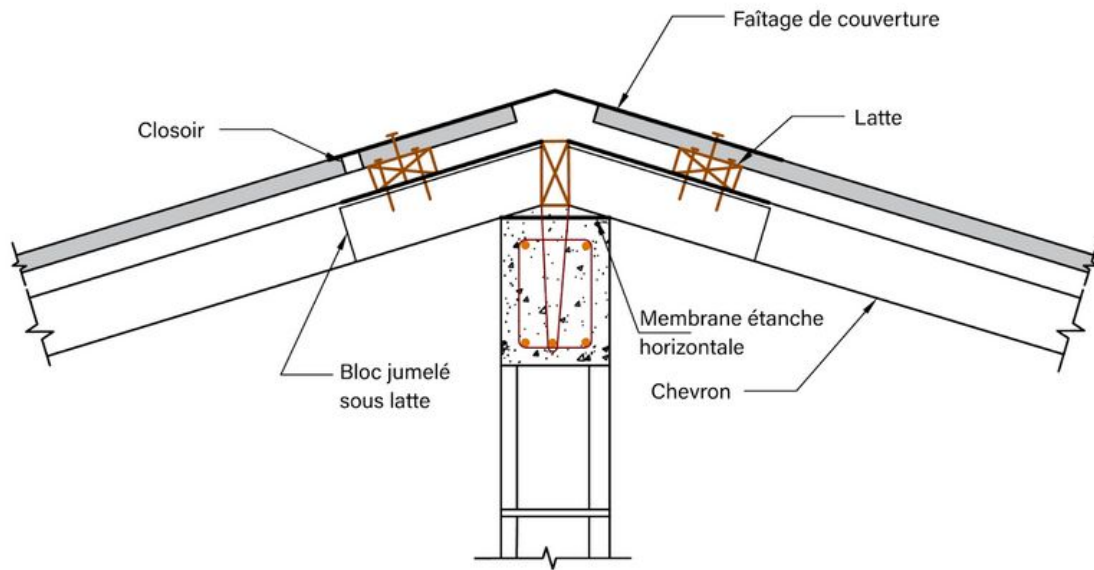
Connexion des chevrons à une planche faitière de faîtage soutenu par un mur de toiture (Option 3)
